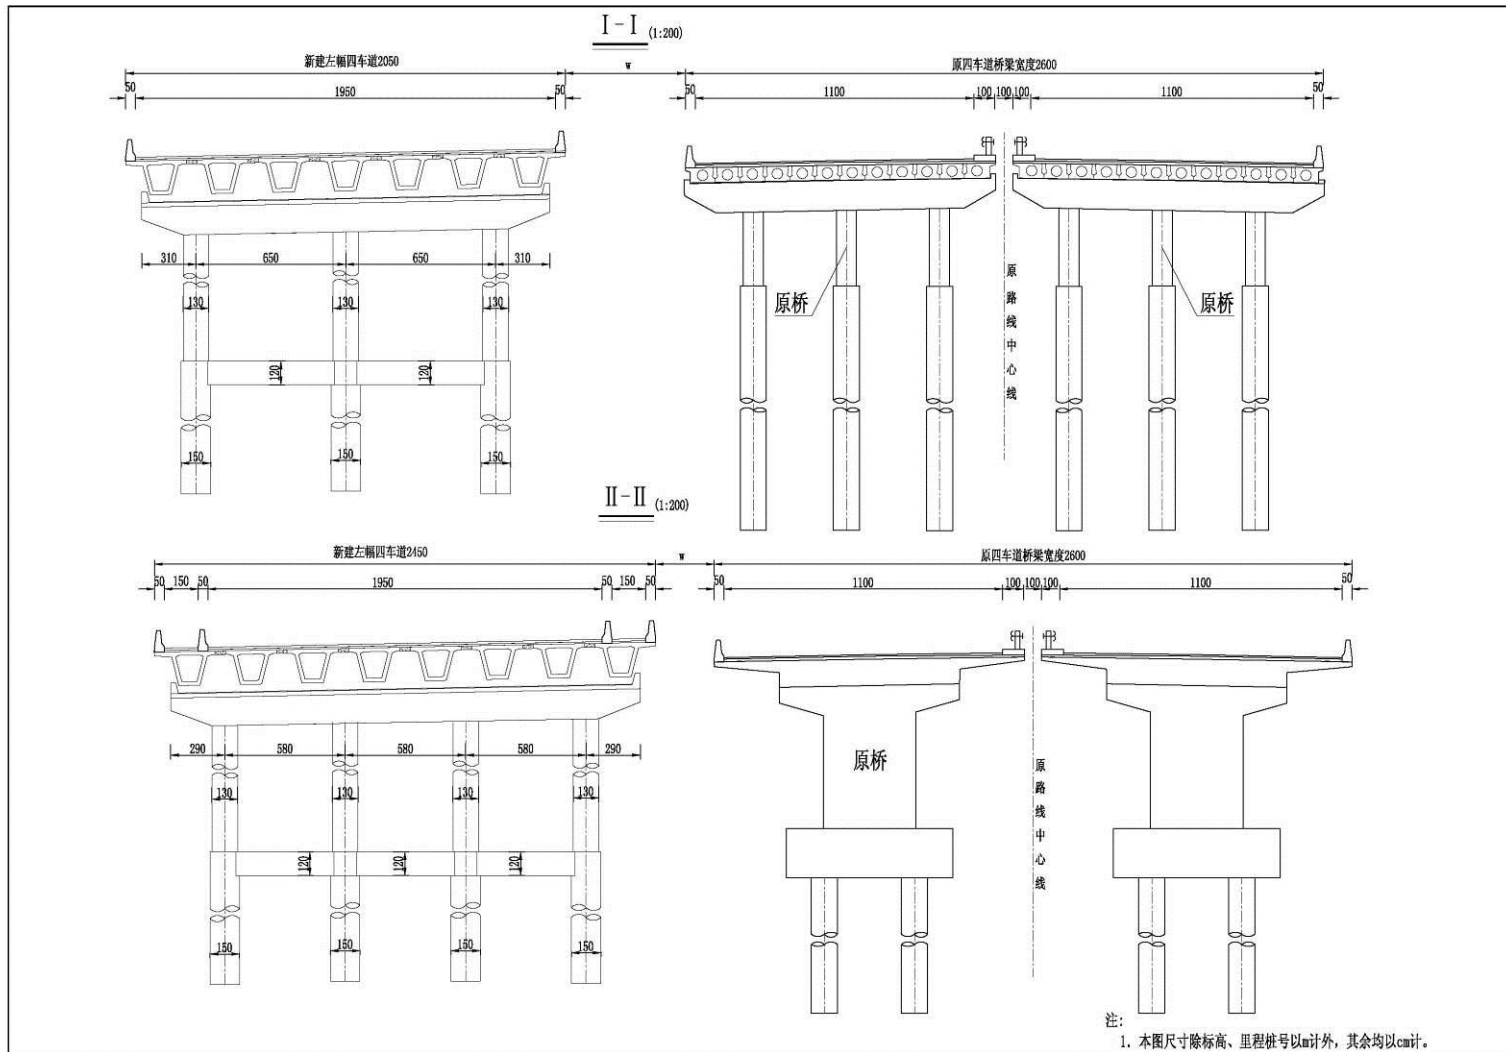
双庙宋至朱君段单侧拼宽方案 1 桥梁横断面图
